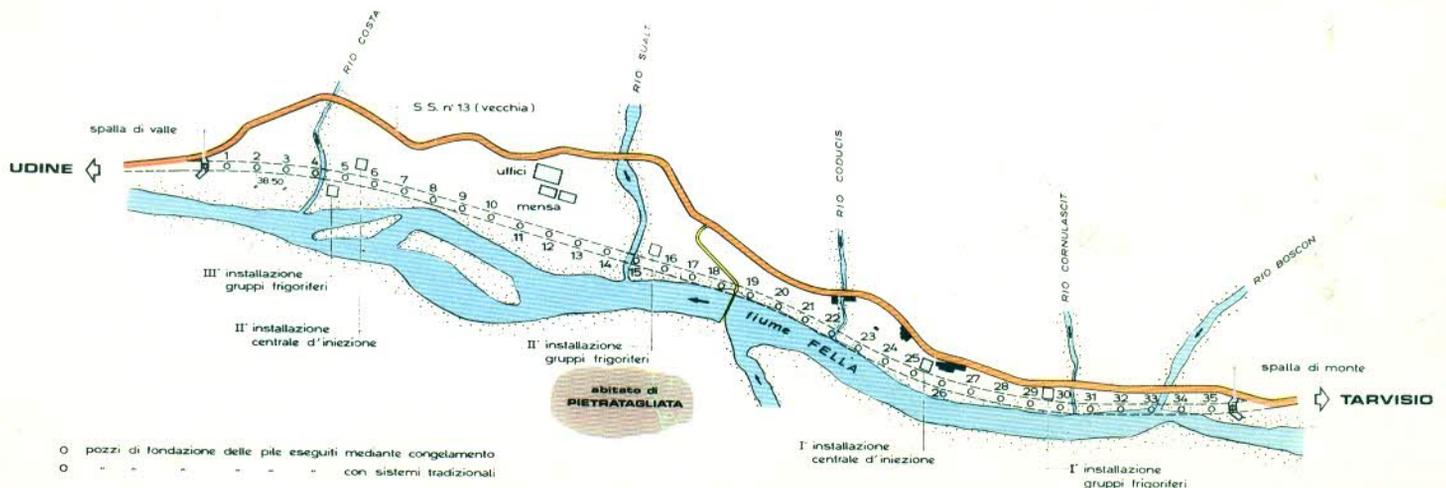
Planimetria del tracciato della variante di Pietratagliata ed installazioni del cantiere □ Layout of the Pietratagliata viaduct. The piers and site installations
